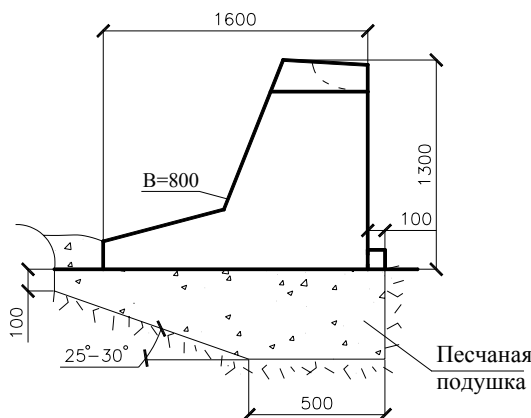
Фундамент типу ФР-16-8 (серія 1.800-2.вип.1)
